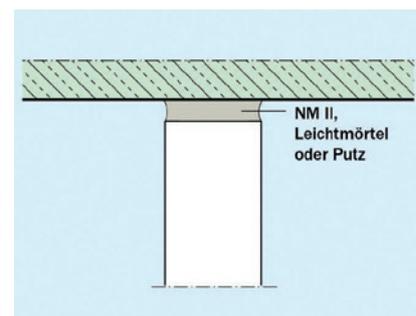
Vermörtelter Anschluss einer nicht tragenden Innenwand an die Geschossdecke [10]
